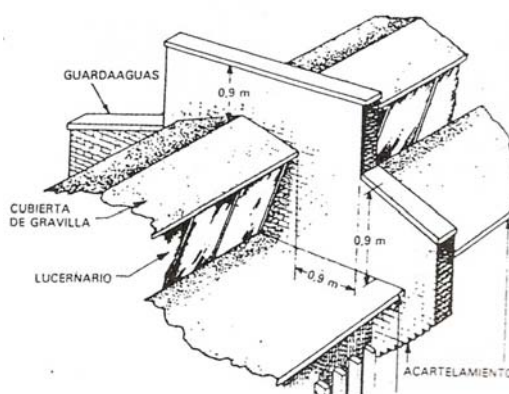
Desenho esquemático do muro de separação exigido pela *Fire Protection Handbook* (NFPA, 1987).
